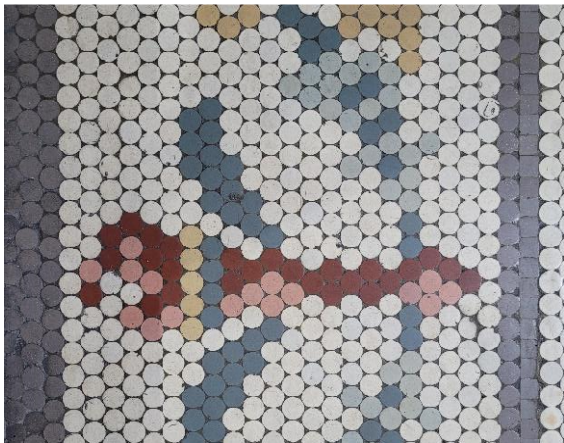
Pastillas conformando motivos de diseño en pavimentos. Acceso a planta alta
